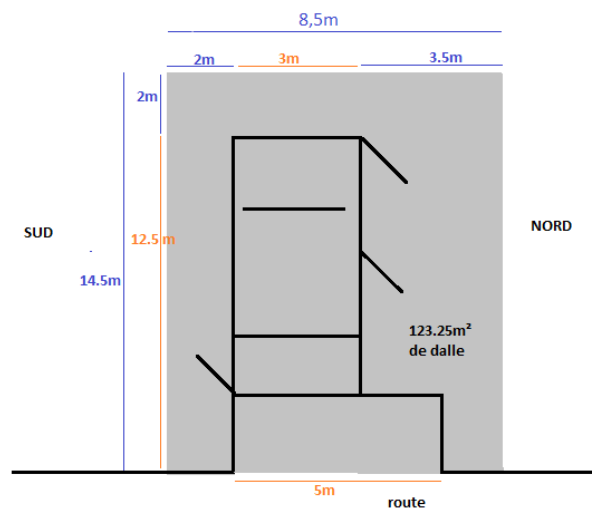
Dimensions de la dalle en béton et position du bâtiment sur celle-ci
